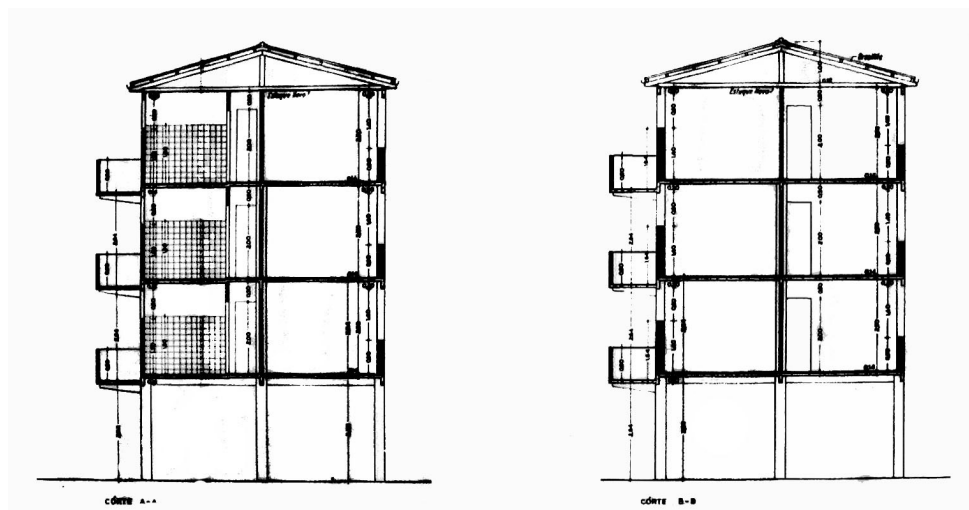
Cortes transversais. Fonte: arquivo INSS.
